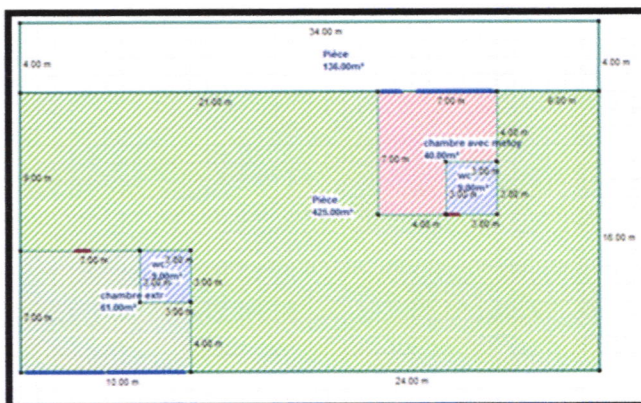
plan 1 er étage dessiné sous Alcyone 1.0
